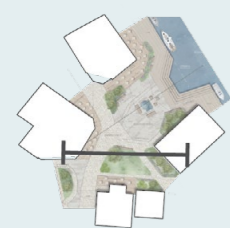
Illustrasjonsplan av Kløckers plass.
